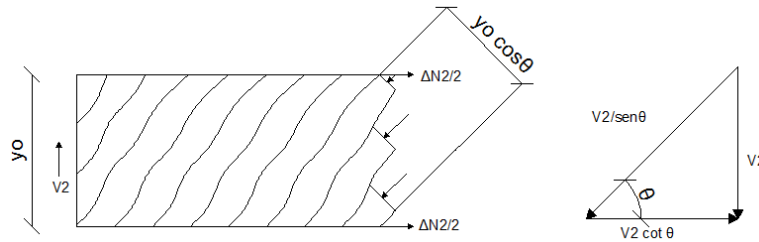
6 Fuerzas de compresión diagonal que actúan en la pared vertical de la viga.
